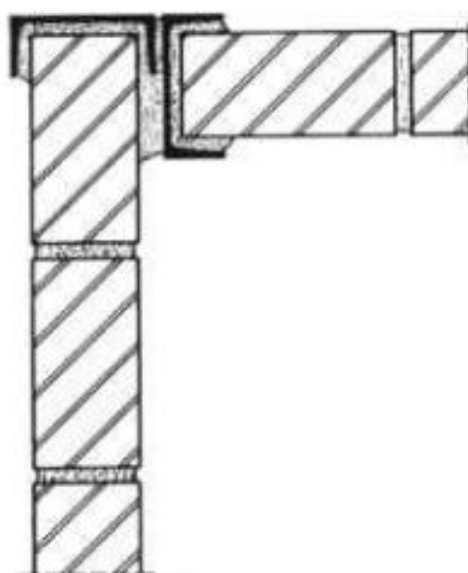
LIGAÇÃO DE CANTO DA ALVENARIA NA ESTRUTURA. PAREDE DE 15 cm.
